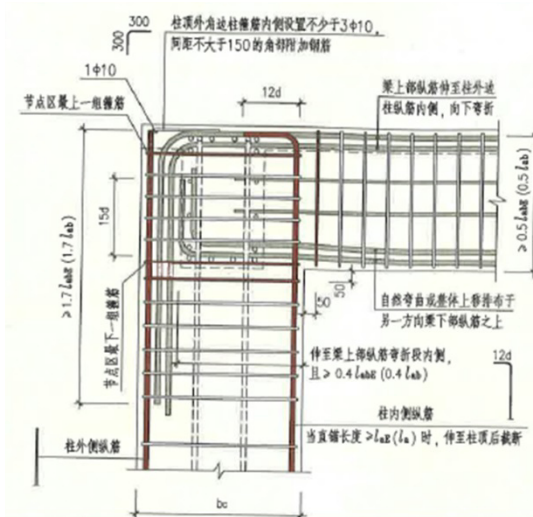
Узел стыка монолитных железобетонных стены и плиты покрытия
